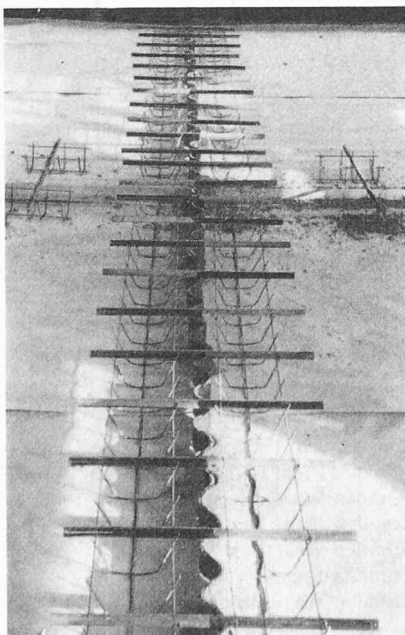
(links): Vor Belagsbetonierung verlegte untere Wellerniteinlage mit Dübeln auf Fugenkörben
